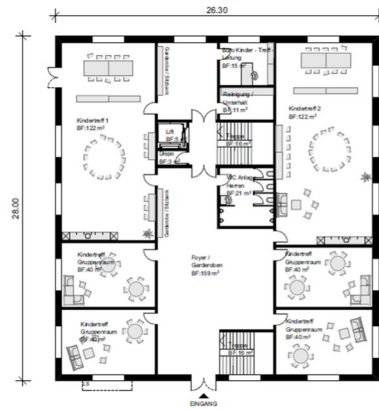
Disposition 03 | Grundriss 1. Obergeschoss
